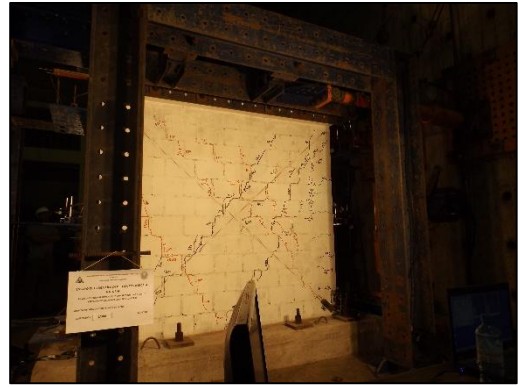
Grieta de más grietas paralelos a las líneas del mortero para una distorsión  $1/300$ .
